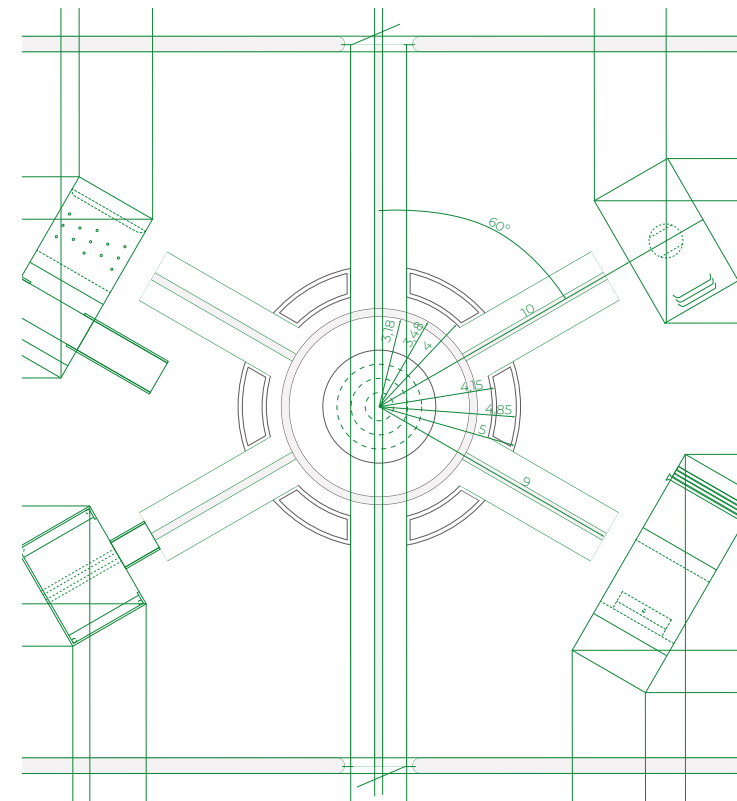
Dibujo constructivo. Planta. Elaboración propia
